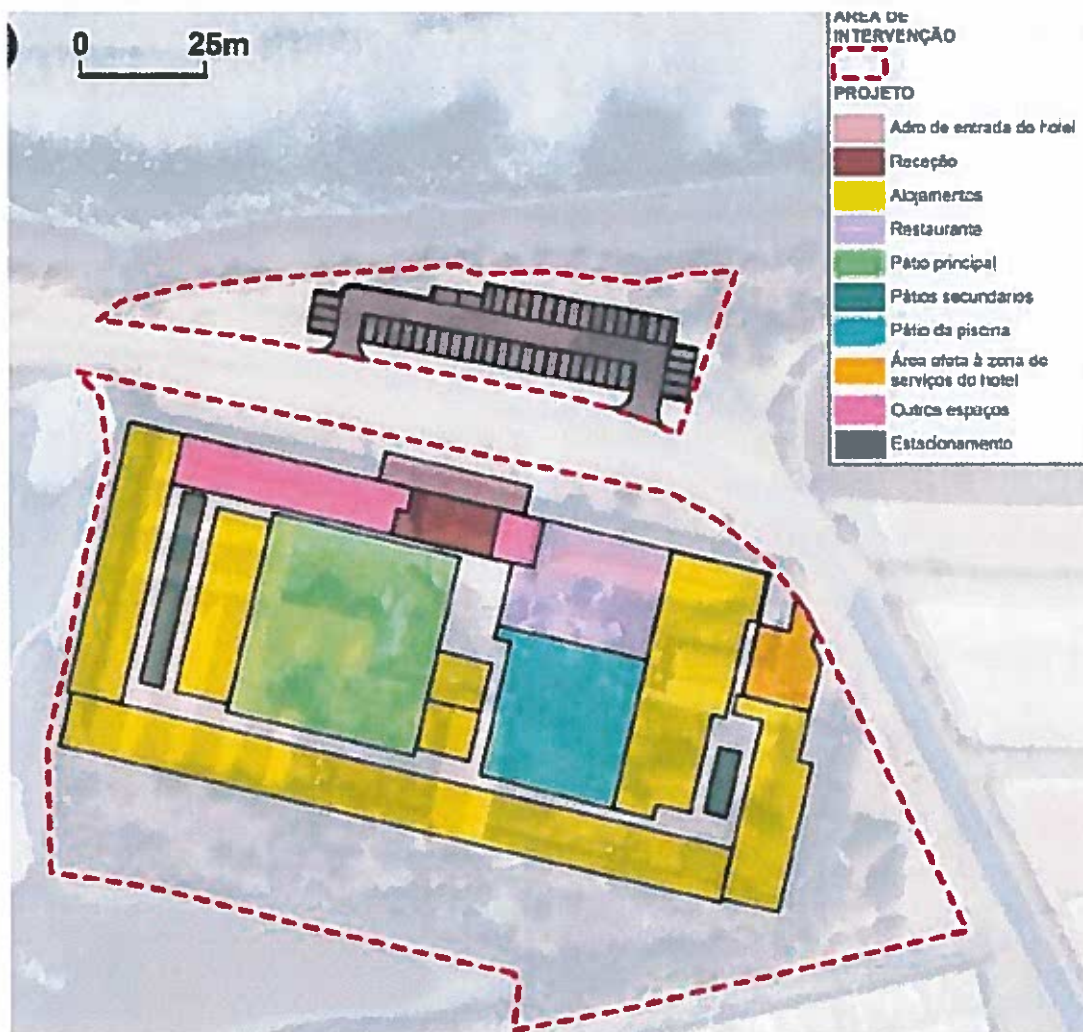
Plano geral do projeto/enquadramento (Fonte: EIA, agosto de 2021)
